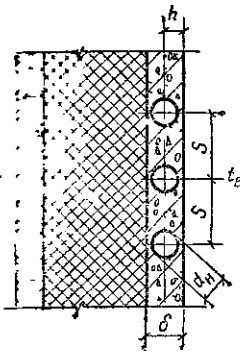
Эскиз размещения нагревательного элемента в наружной стеновой панели
